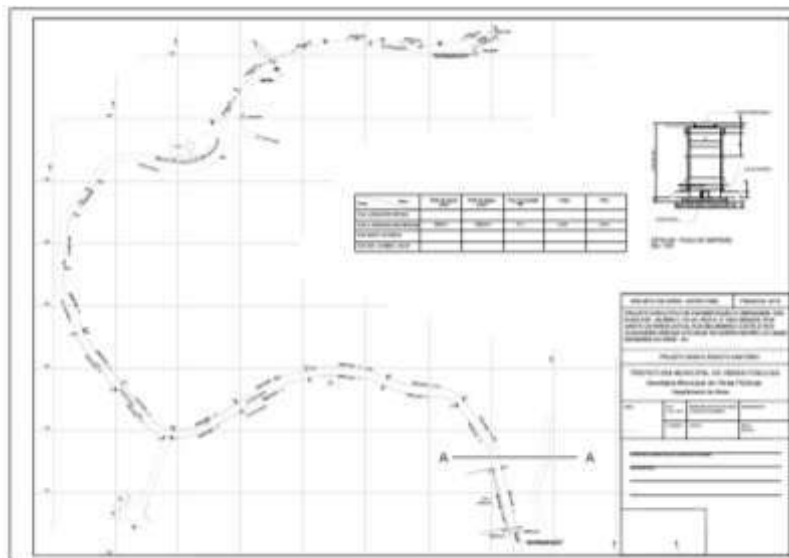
Prancha 10/13 – Projeto de Esgoto Sanitário.
